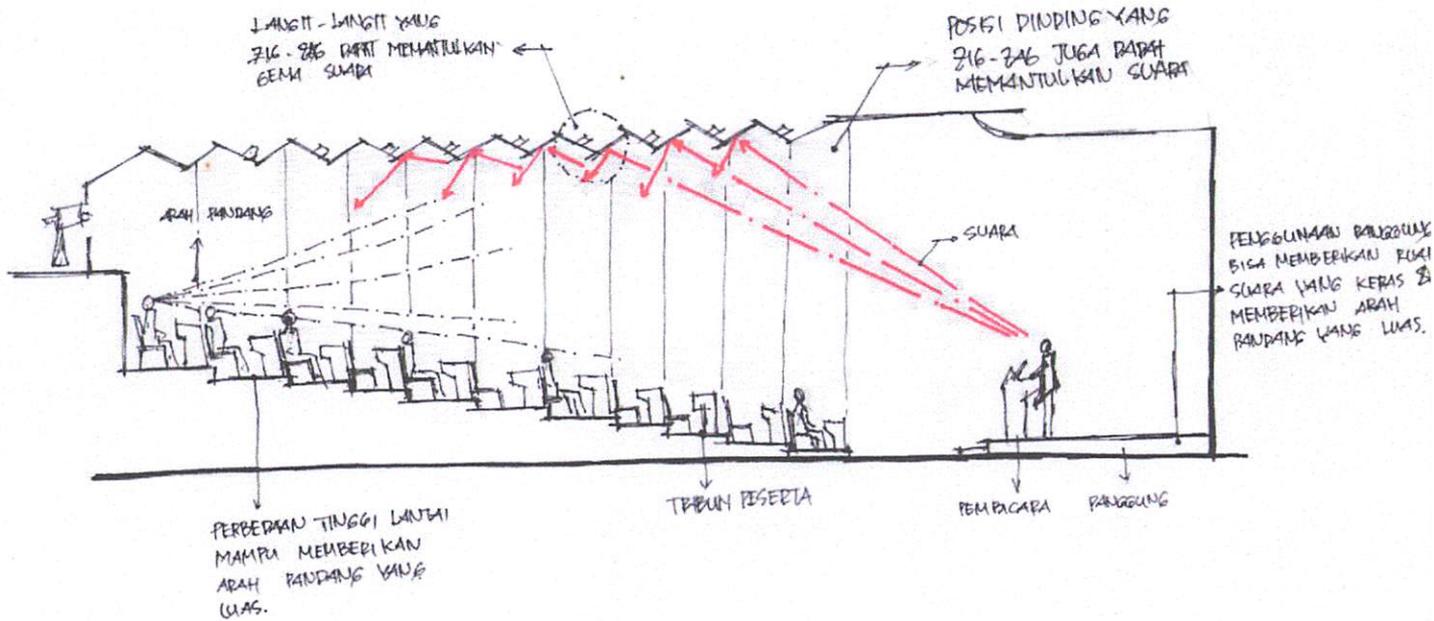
Sketsa Desain Bentuk bangunan
